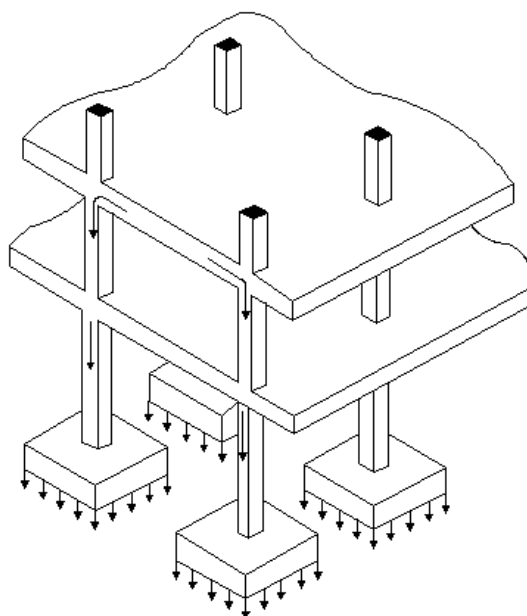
caminhamento das cargas de lajes apoiadas diretamente sobre pilares (SPOHR, 2008).
